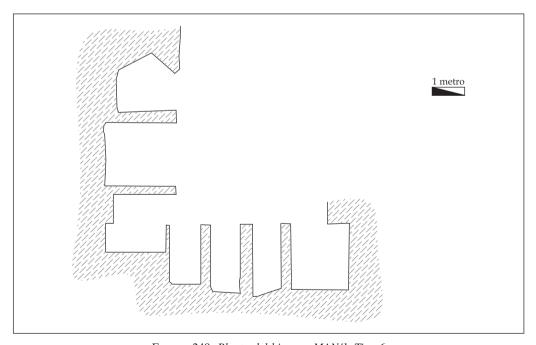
Planta del hipogeo MAN/1. Tipo 6
